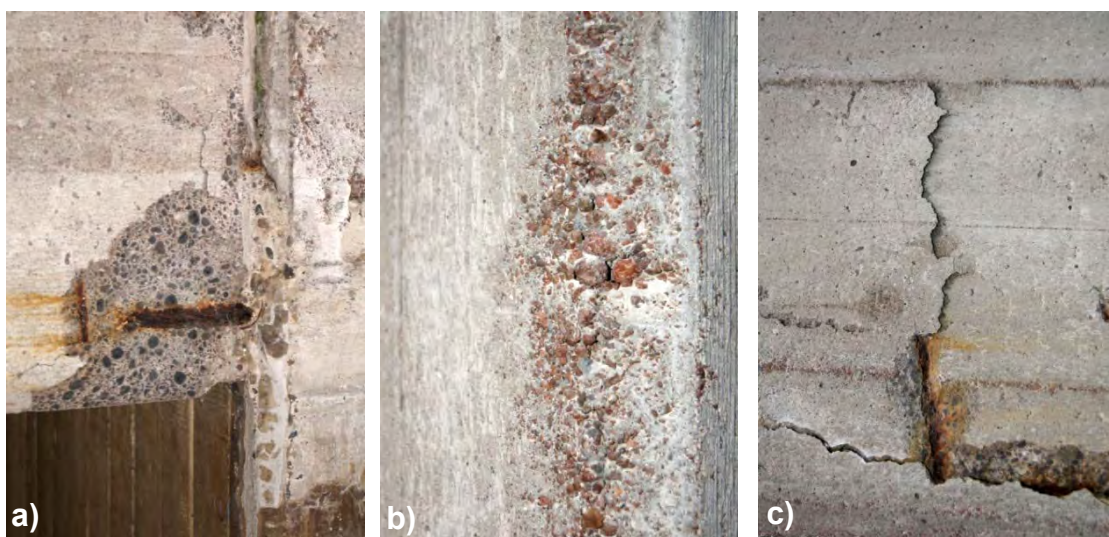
a) korrodierte Bewehrung; b) Kiesnester; c) Risse, Abplatzungen [1]
